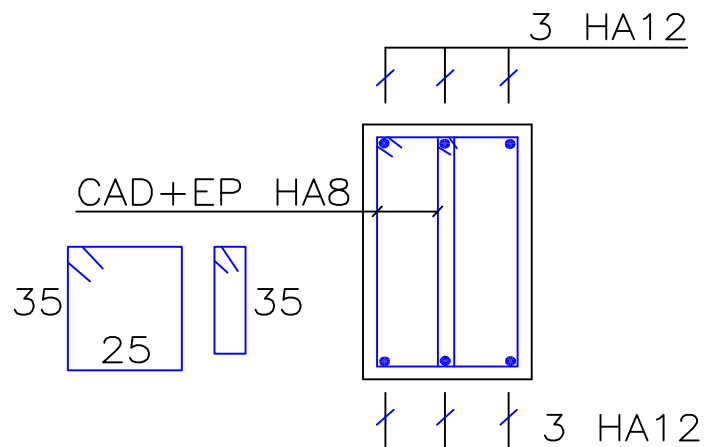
Ferrailage des poutres secondaires au niveaux terrasse
